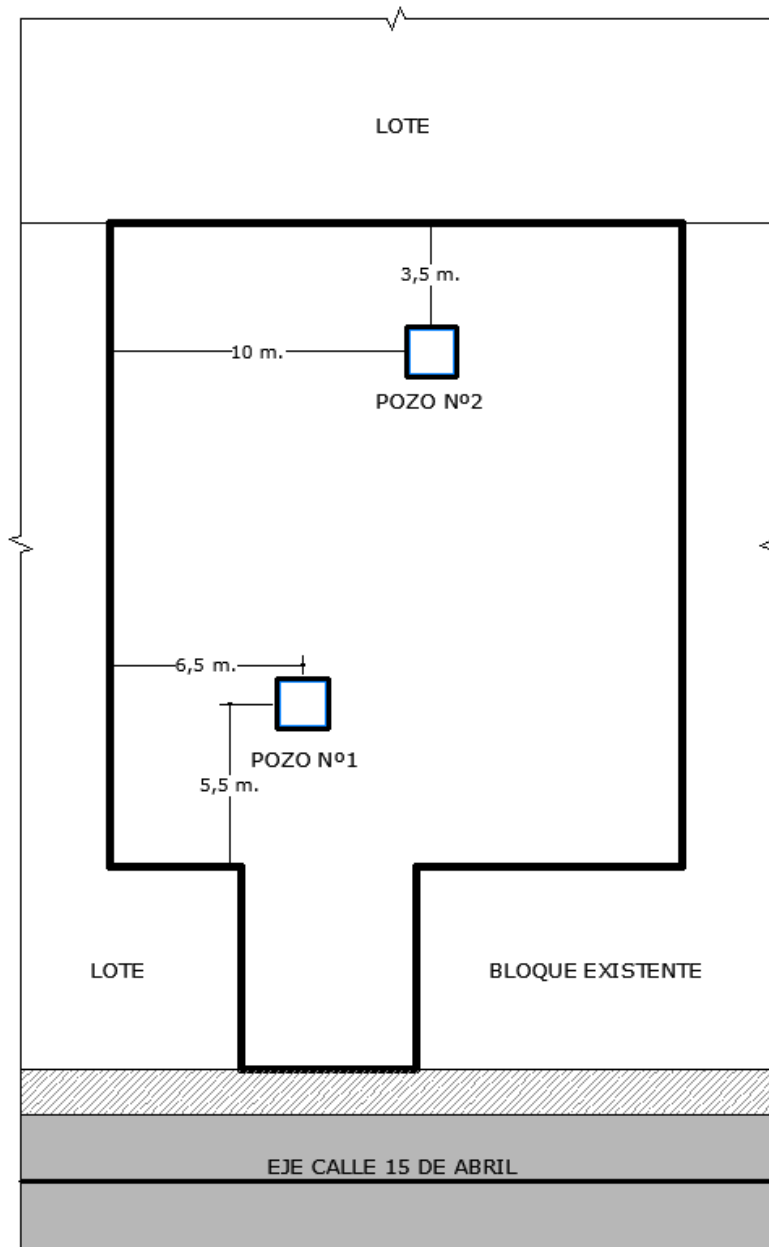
Croquis de Ubicación de Pozos de Sondeo, Elaboración Propia
